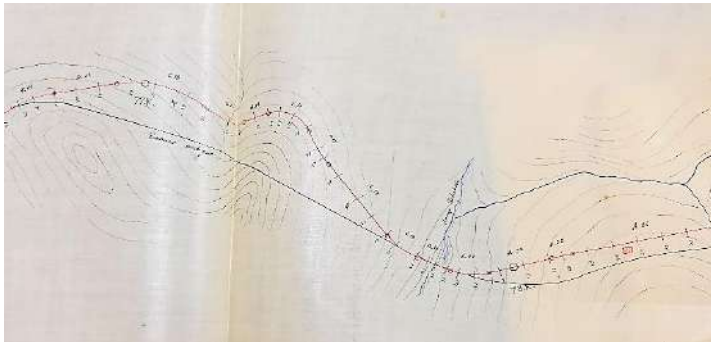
Trazado de la carretera en la zona del puente sobre el arroyo del Helechoso.
